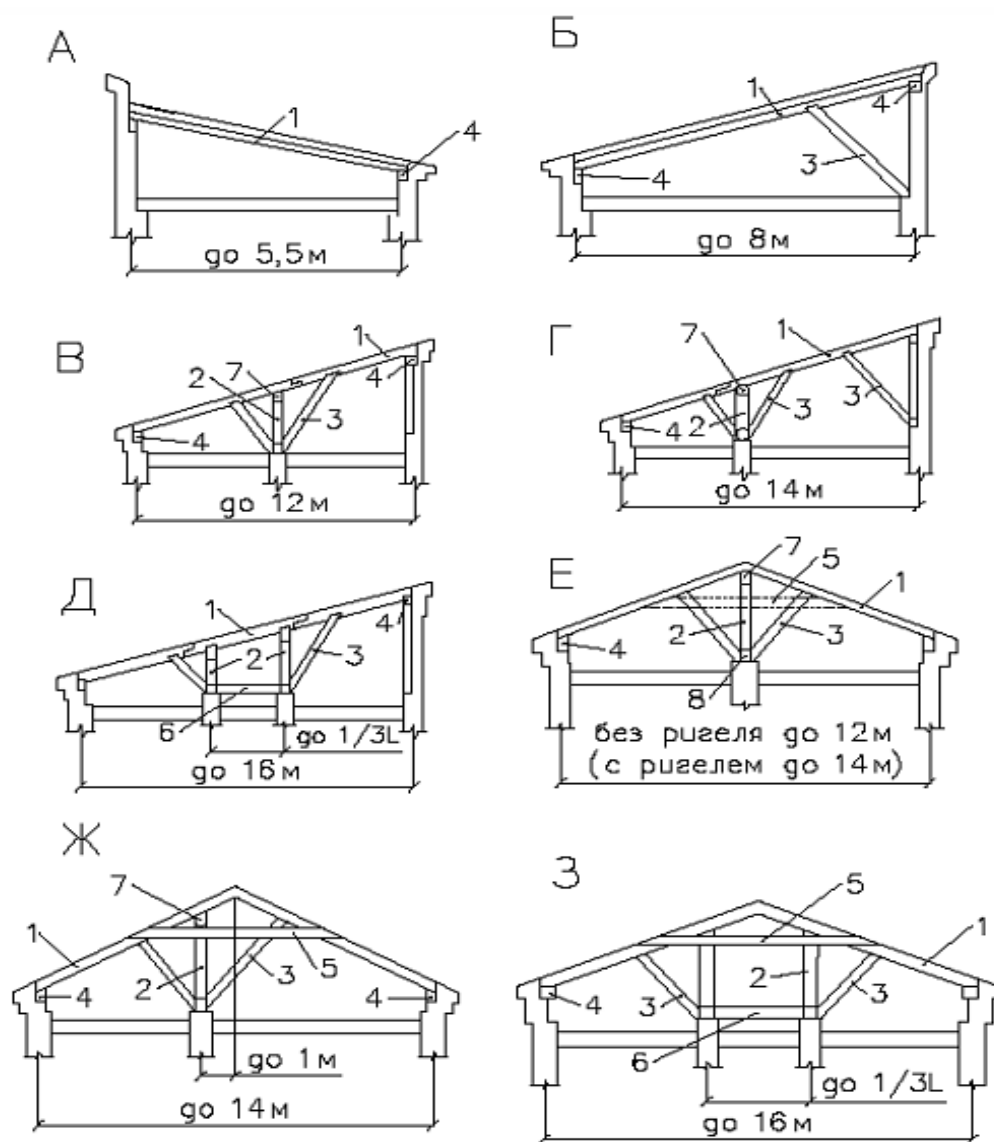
Конструктивные схемы деревянных наслонных стропил:
